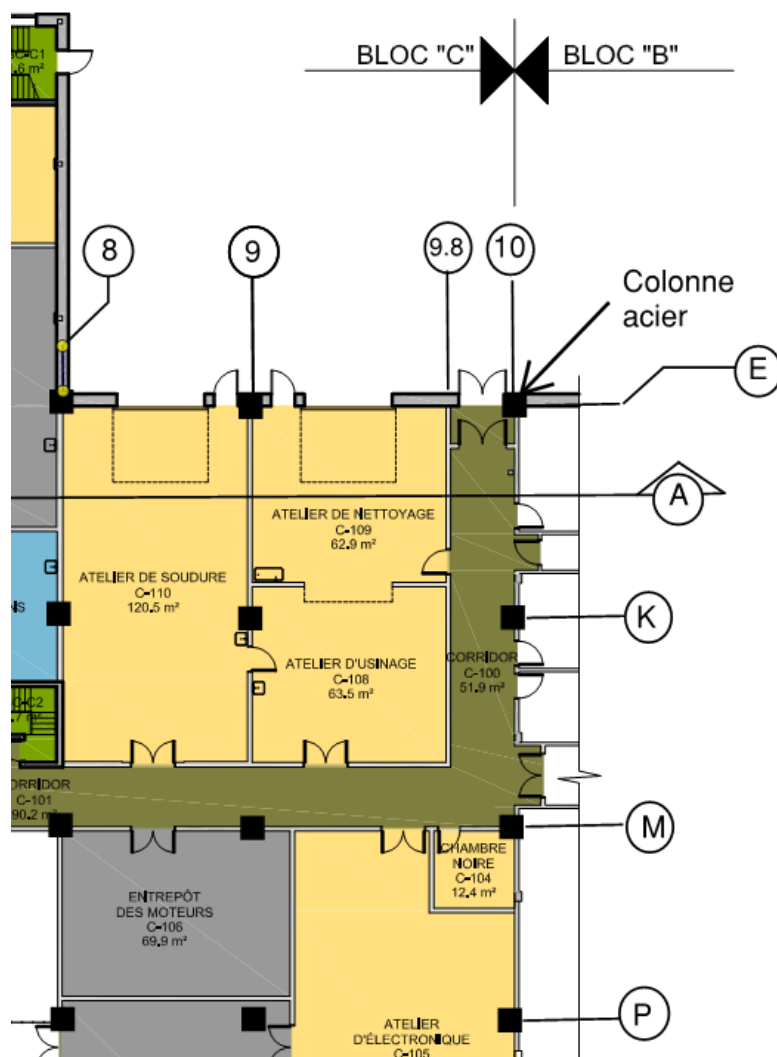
Vue en plan de l'aménagement des locaux dans le secteur des travaux projetés
